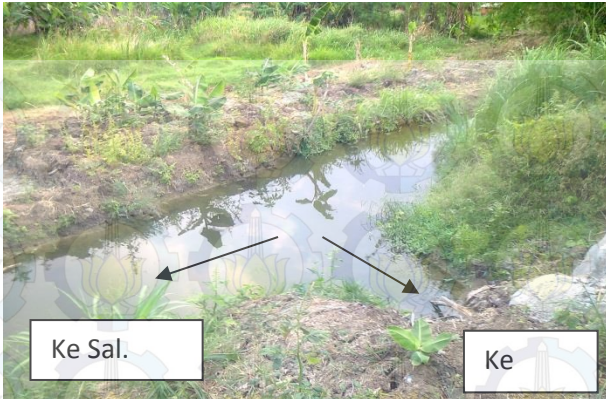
Outlet saluran pembuang (saluran Baru)
